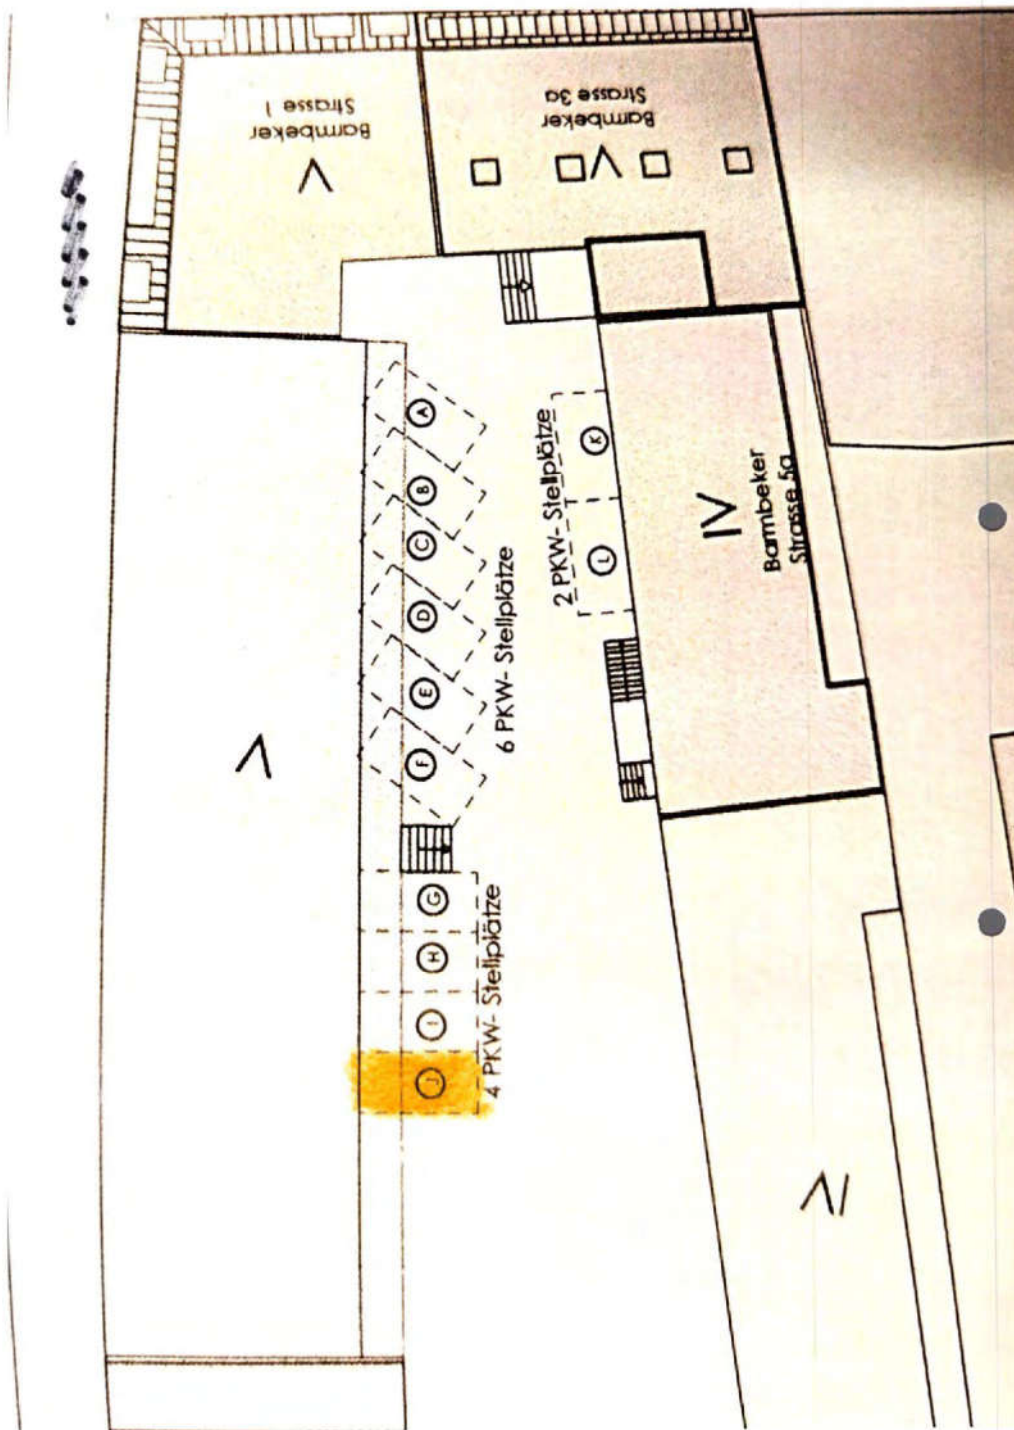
Lageplan mit Kennzeichnung Sondernutzungsrecht Stellplatz
